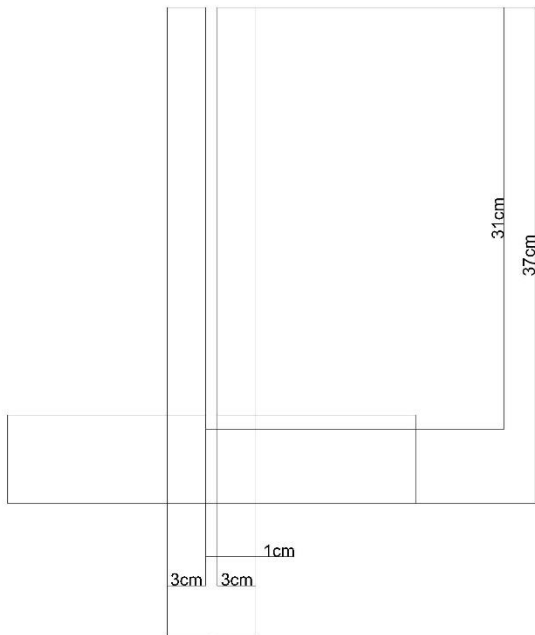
Pie de cierre perimetral vista frontal, Elaboración propia
